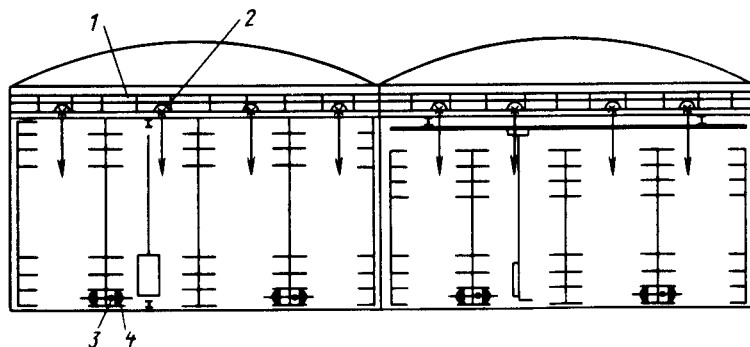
Освещение складов с кранами-штабелерами. Вариант установки светильников на светотехнических мостиках:
